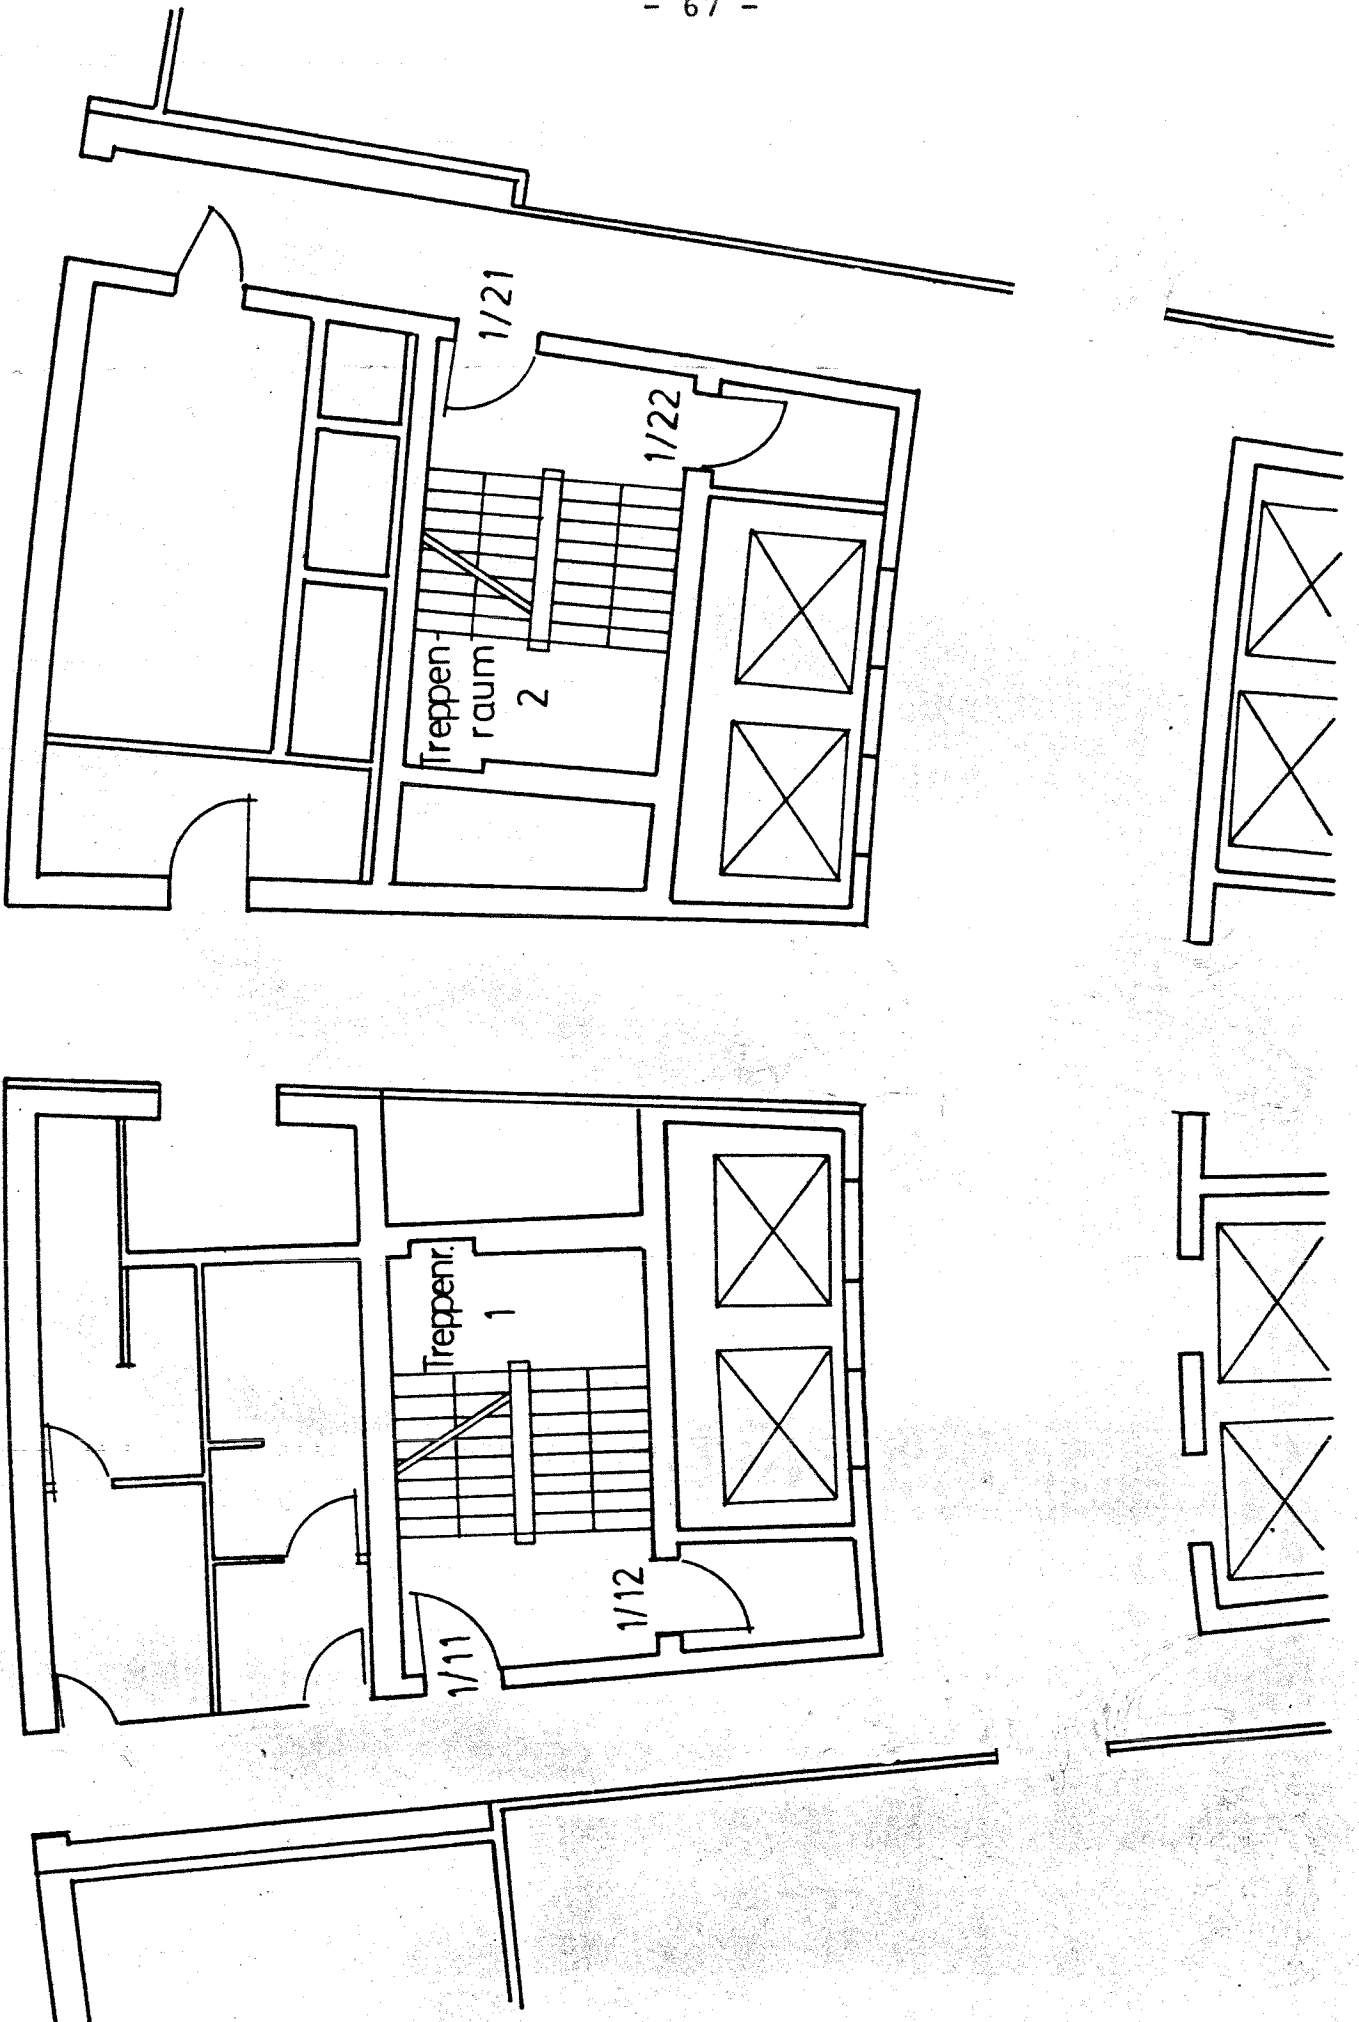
1.Obergeschoß, eingebaute Türen beim Brandversuch
